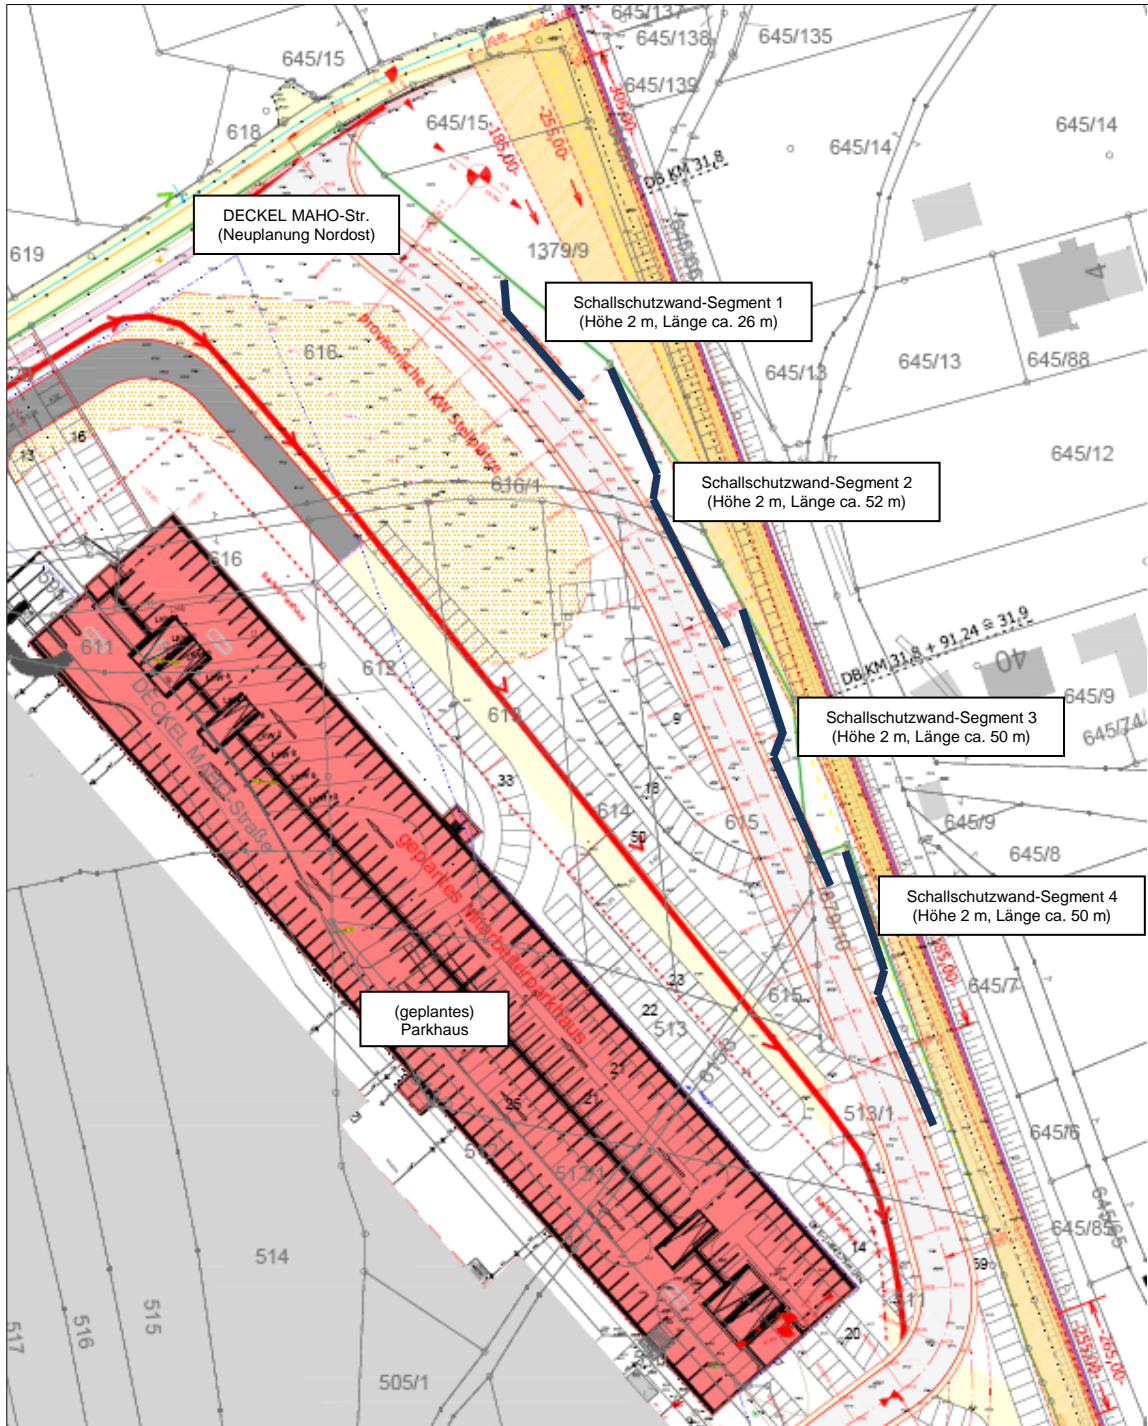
Darstellung der geplanten baulich konstruktiven Schallschutzmaßnahme entlang des nordöstlichen Abschnitts der neugeplanten DECKEL MAHO-Straße
